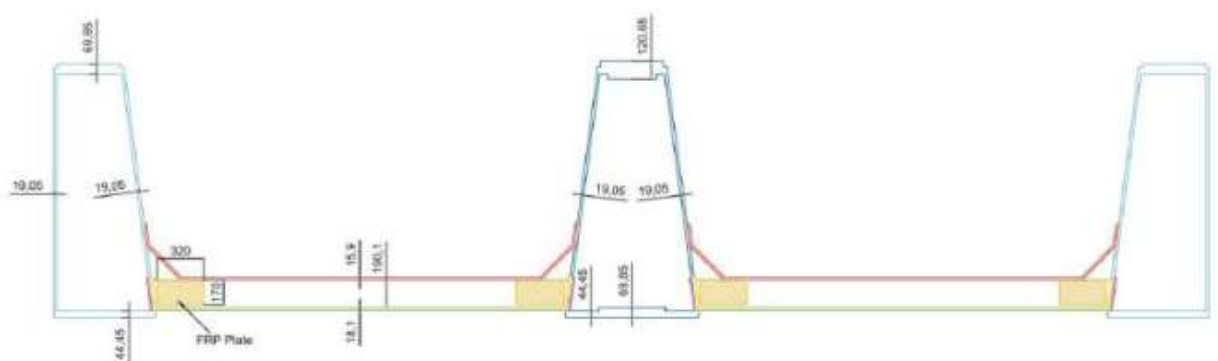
Seção transversal no meio do vão (dimensões em mm)
